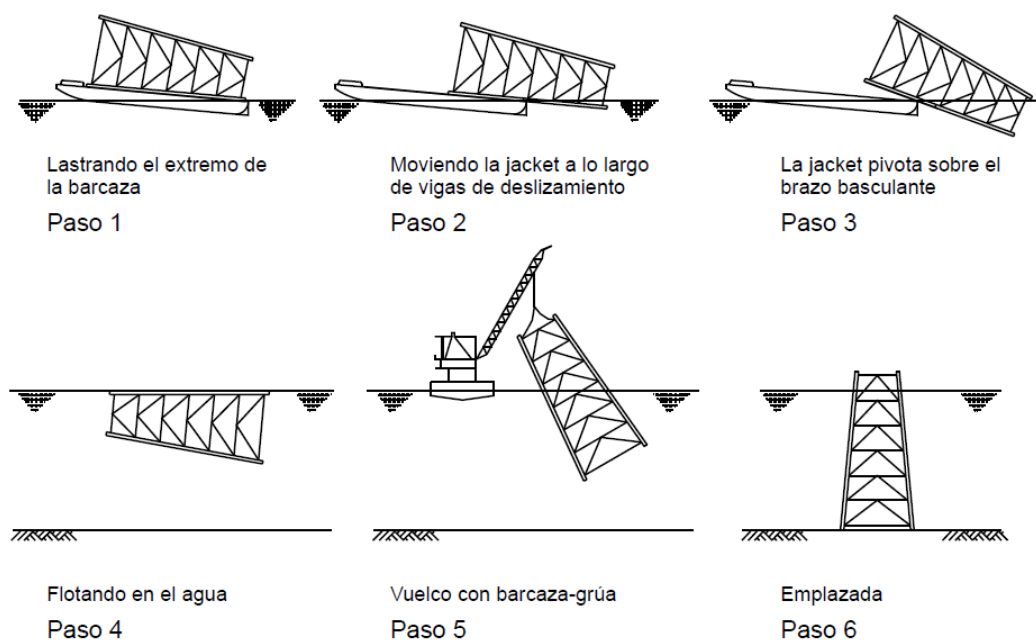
Instalación de la jacket mediante lanzado. Fuente: Instituto Técnico de la Estructura en Acero
